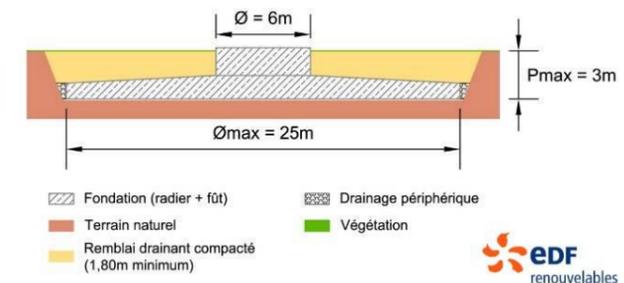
Principe de dimensionnement d'une fondation d'une éolienne
